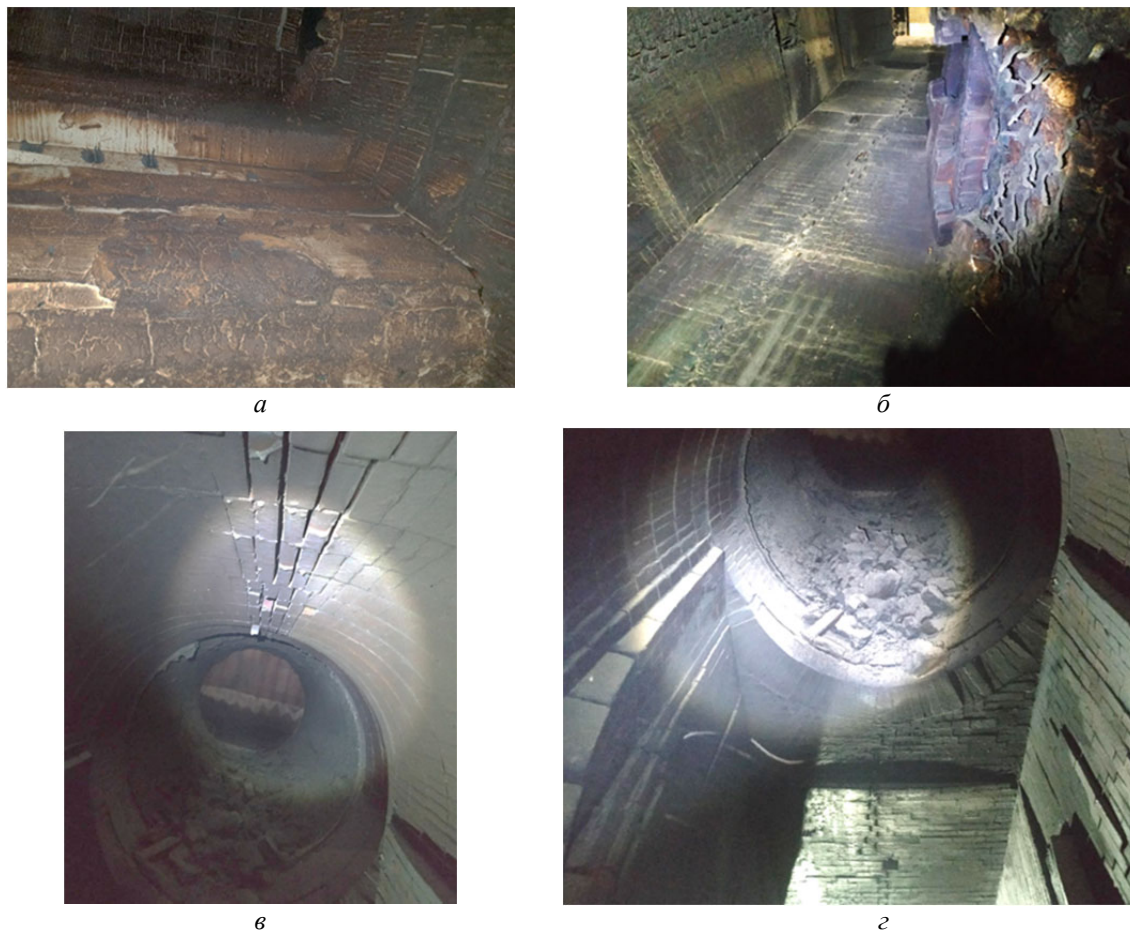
Характерные виды разрушения футеровки камеры дожига котла-утилизатора дымовых газов:
